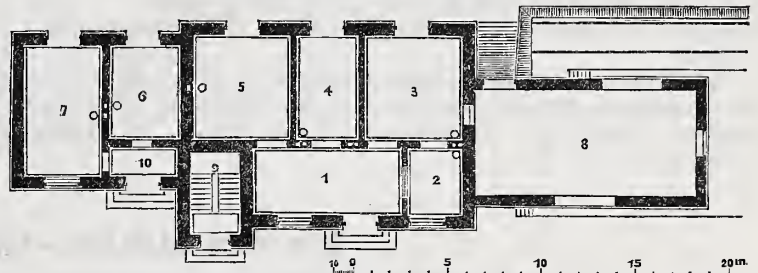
Grundriss vom Erdgeschoss.
